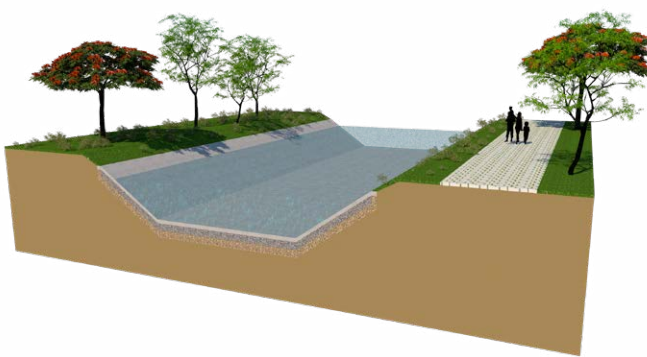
Secciones tipo 1 de canales a cielo abierto de sección trapezoidal de concreto.
